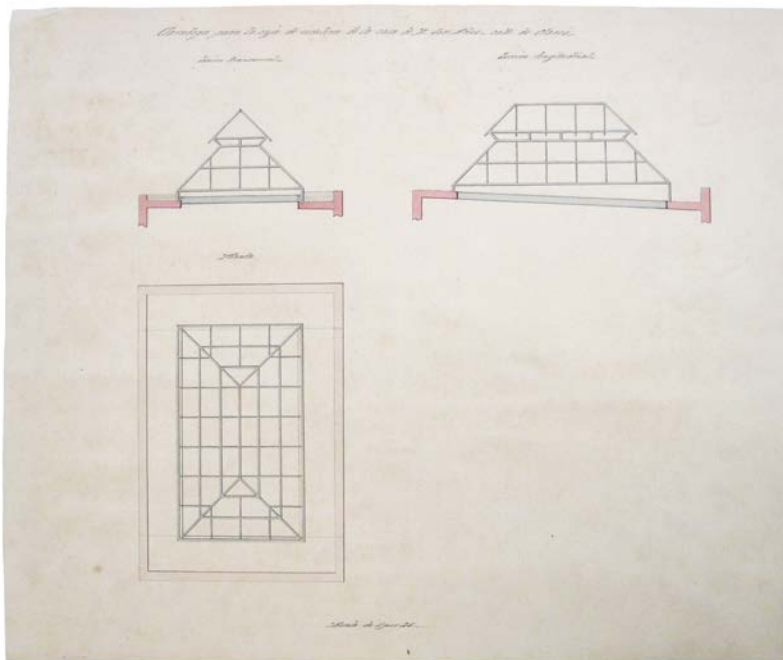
Planta, alçat i secció de claraboia (casa José Anés, arquitectes Bassegoda, 1881). Font: AHCOAC (H102D/7/501.33).
